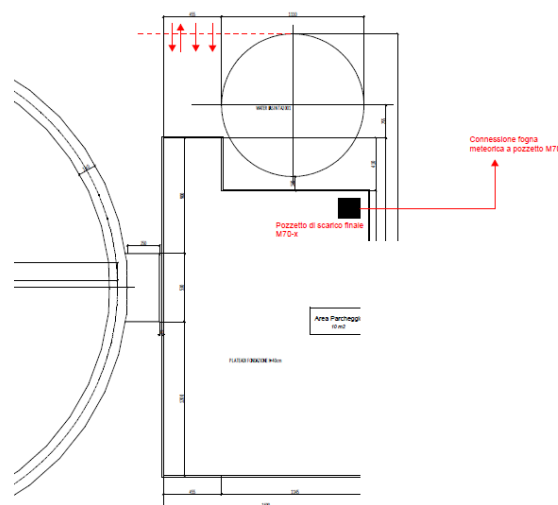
Dettaglio del layout fondazioni con indicazione del pozzetto M70-x
